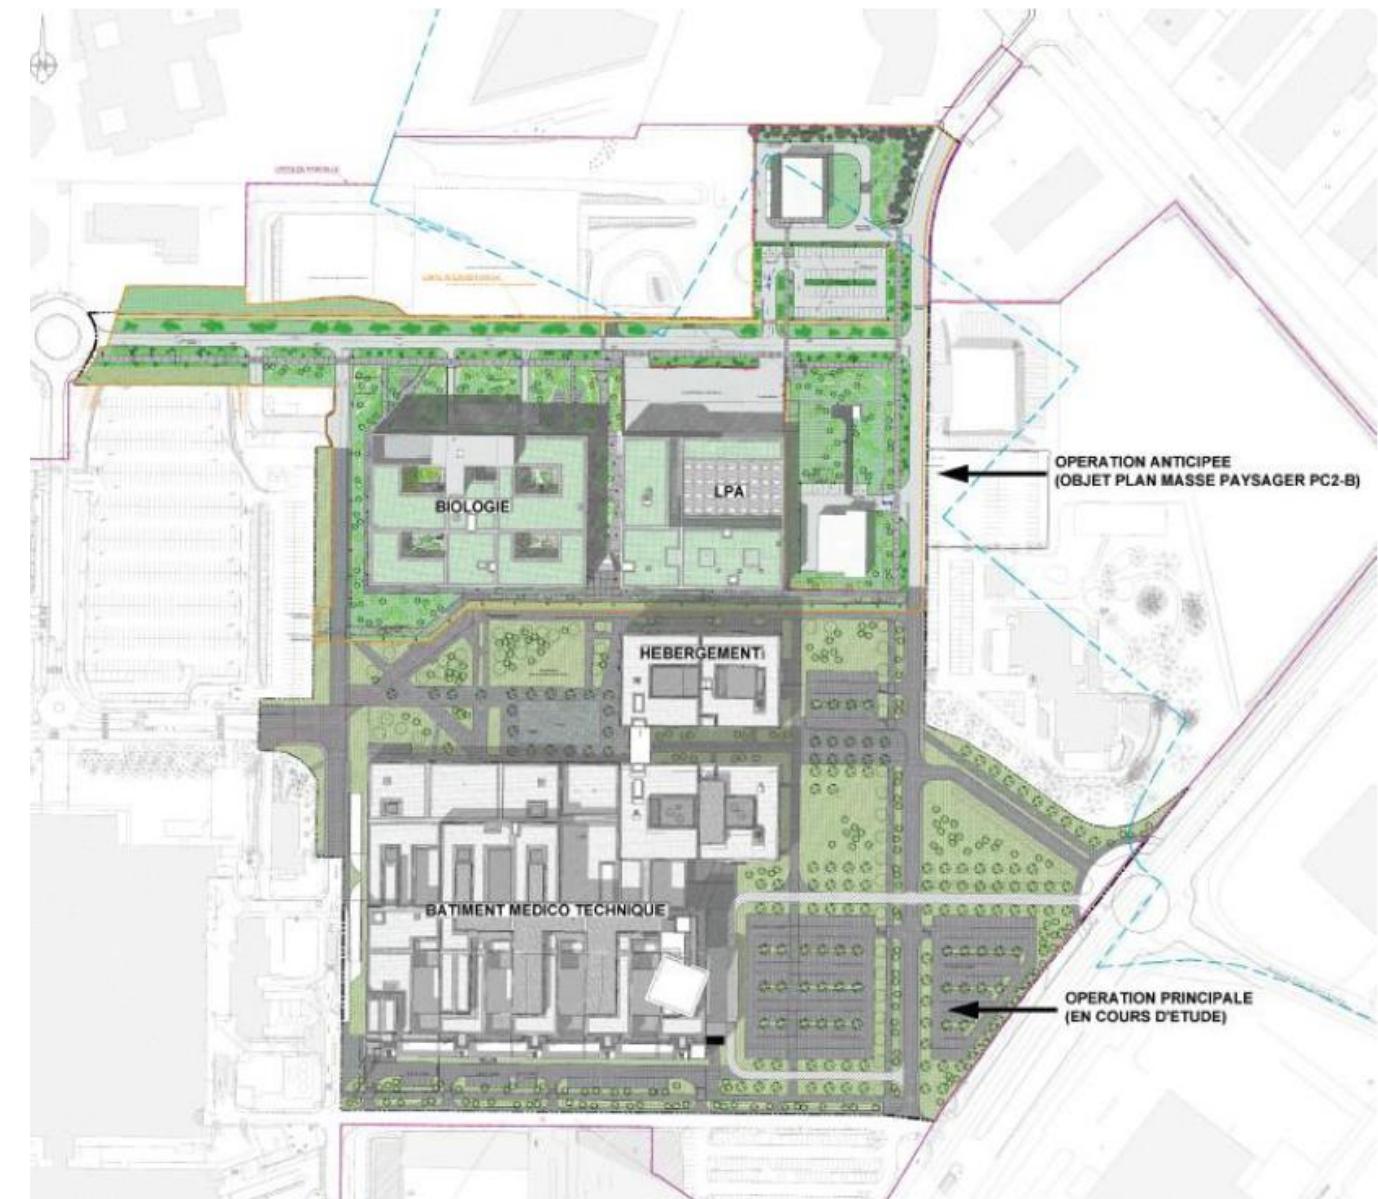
Plan de masse du projet de reconstruction du CHU de Caen (source : Avis MRAe du 16/03/2020)
